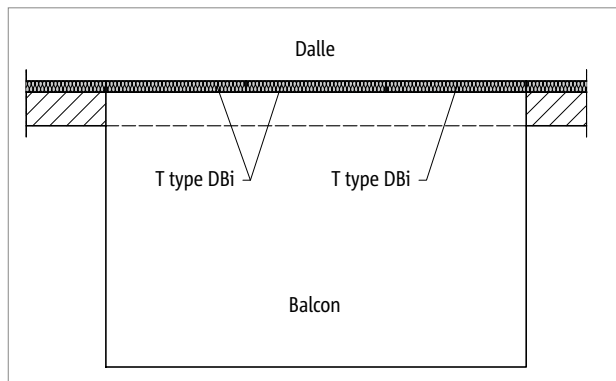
Schöck Rutherma® T type DBi : balcon en porte-à-faux et dalle en béton coulé sur place
